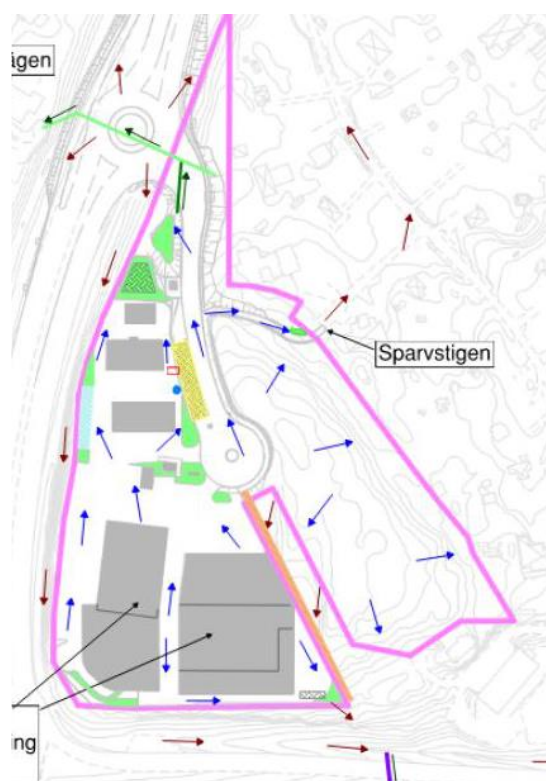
Utdrag ur Planbeskrivning, antagandehandling, sid 32.
